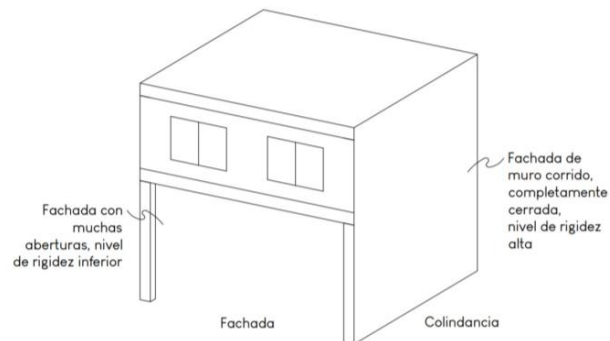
Ilustra el problema existente con colindancias cerradas y fachadas abiertas
